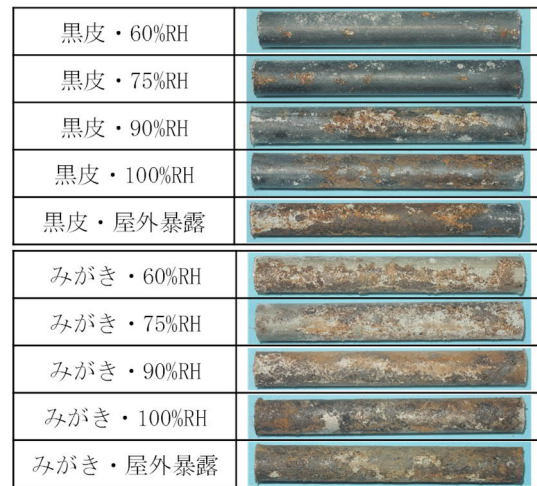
中性化後のコンクリート中の鉄筋腐食状況 (暴露期間 2368 日)
